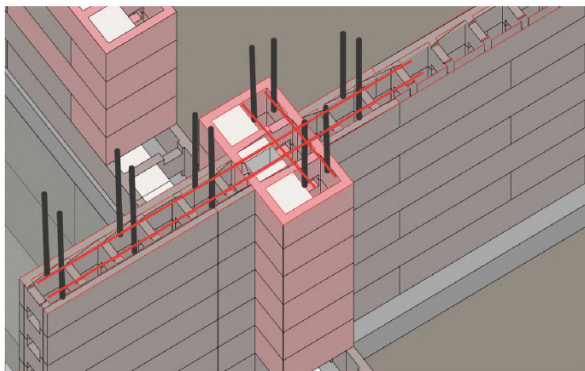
Схема армирования кладки из блоков вертикальными и горизонтальными стержнями
